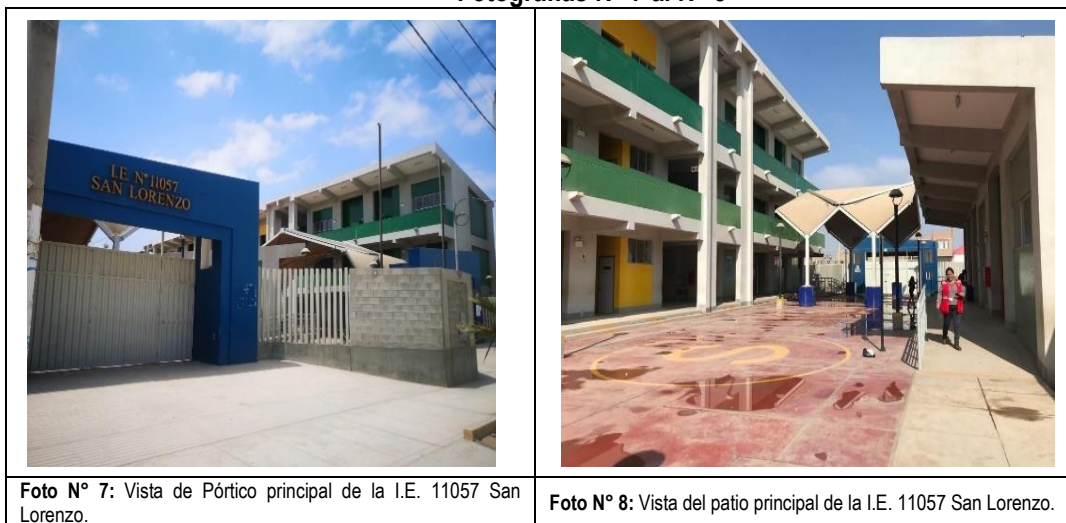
Vista de Pórtico principal de la I.E. 11057 San Lorenzo.
